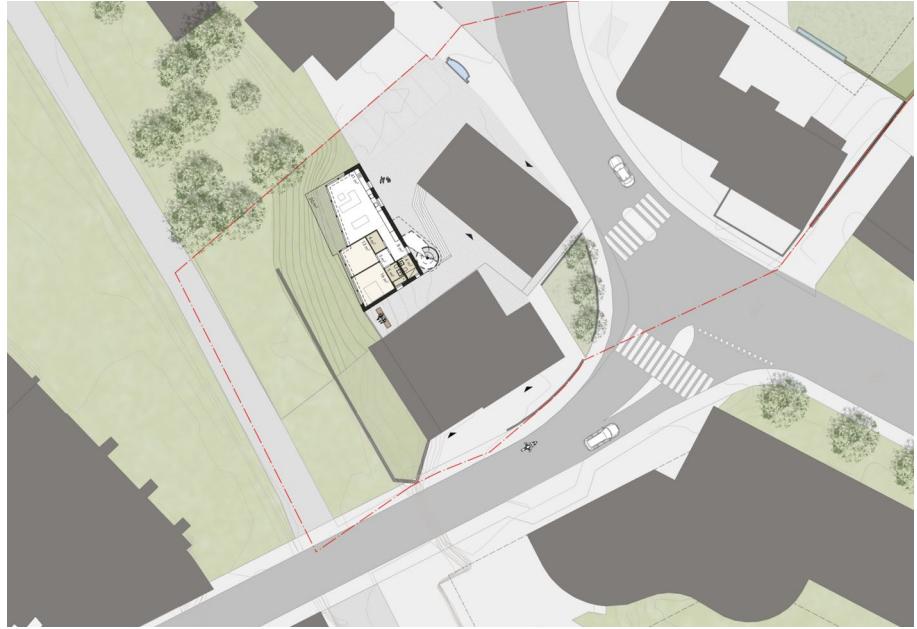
Situations- und Außenraumplan Teilgebiet 2 (am Stadtgraben) am Workshop 3
